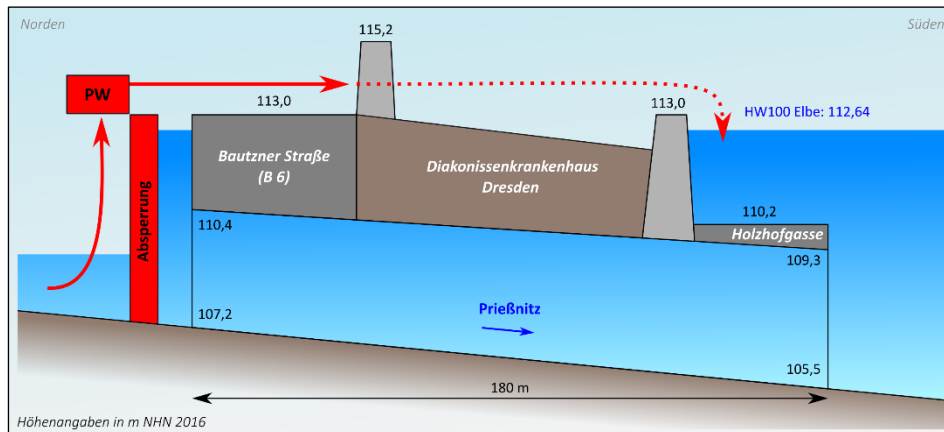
Absperrung gegen Elbehochwasser oberhalb Bautzner Straße – Ableitung über Untertunnelung – Variante 1 a
